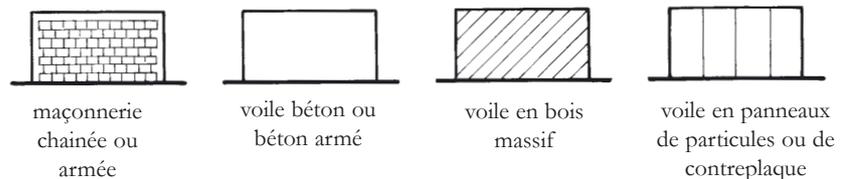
Panneaux rigides assurant le contreventement vertical.
